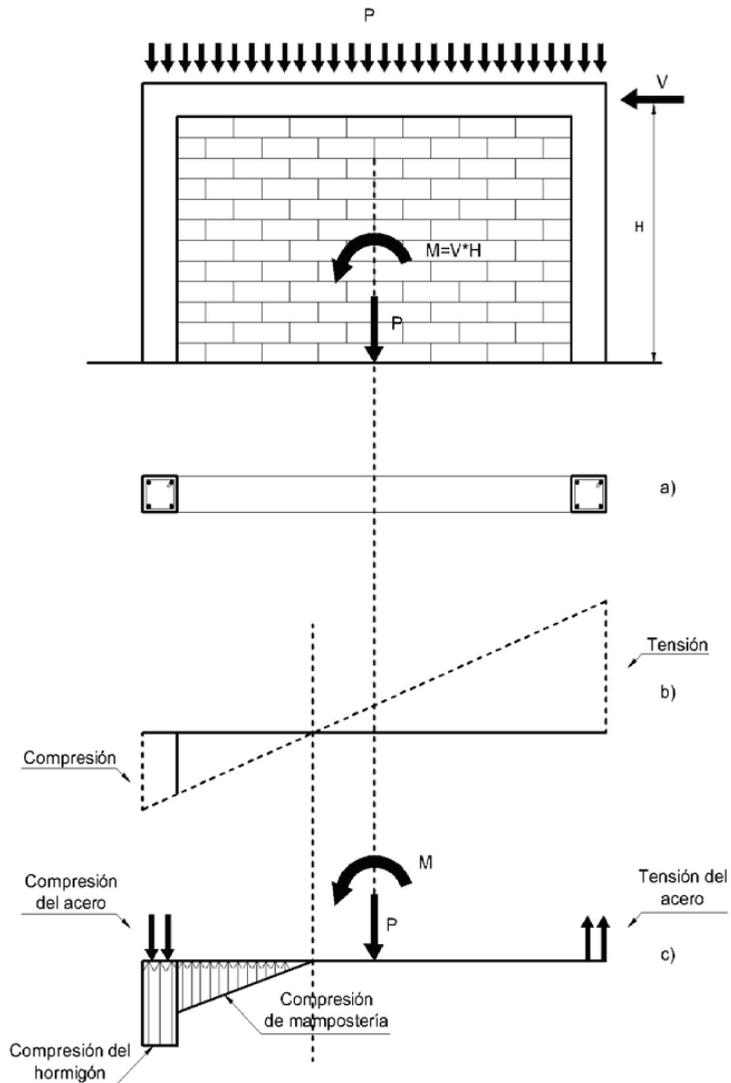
Detalle del Panel de Mampostería Confinada sujeto a acción combinada de carga axial y lateral
